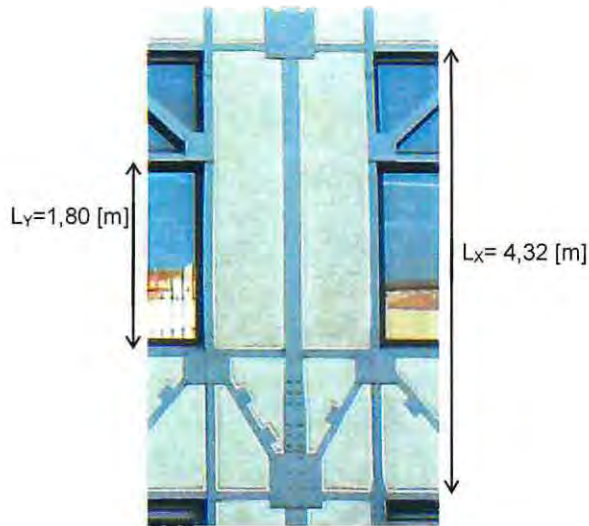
Esquema longitud efectiva columna de fachada.
